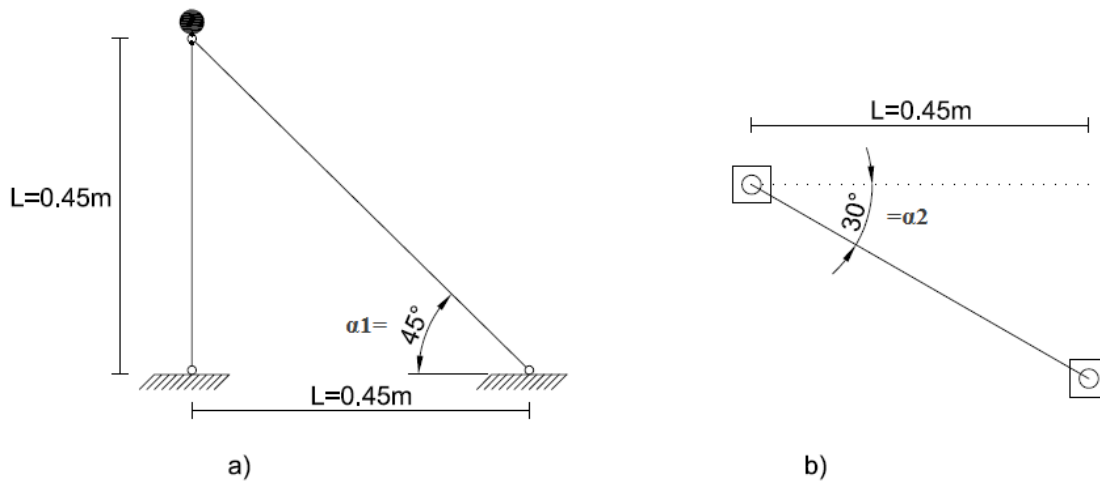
Modelo do sistema estrutural em estudo, pedestal + contraventamento; a) vista no plano vertical; b) vista em planta
